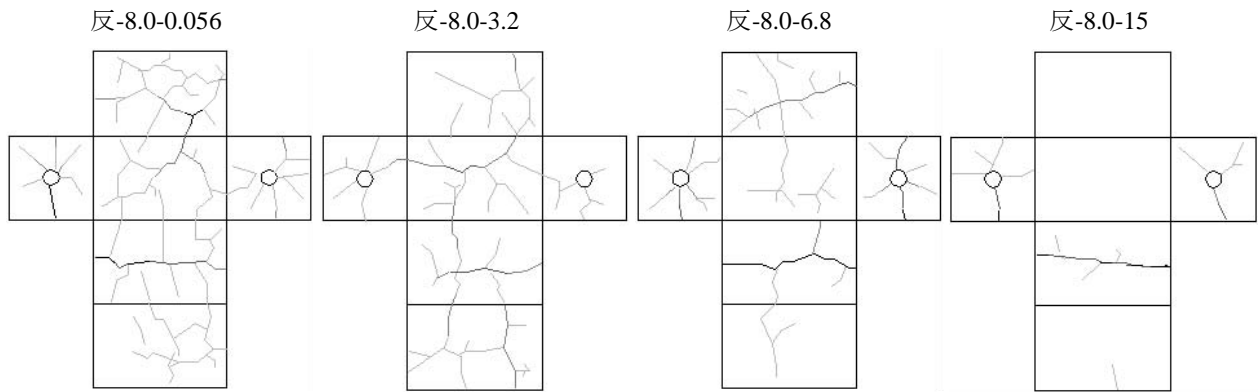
ひび割れ展開図（材齢 8 ヶ月）
